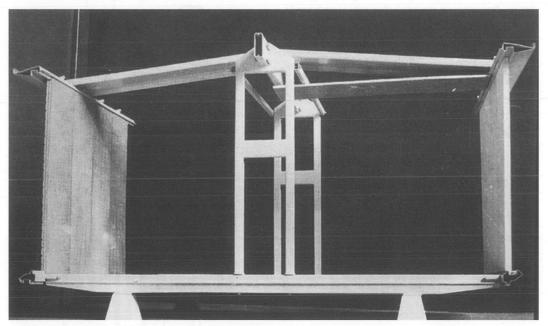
Maqueta del montaje del barracón desmontable planteado con el sistema de pórtico central (Sulze 2000)
